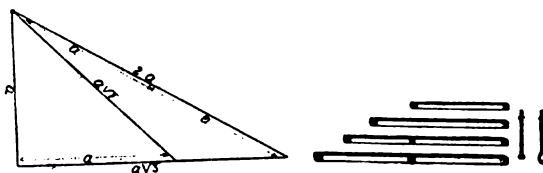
Triangolo rettangolo fatto mediante « poutrelles ».
